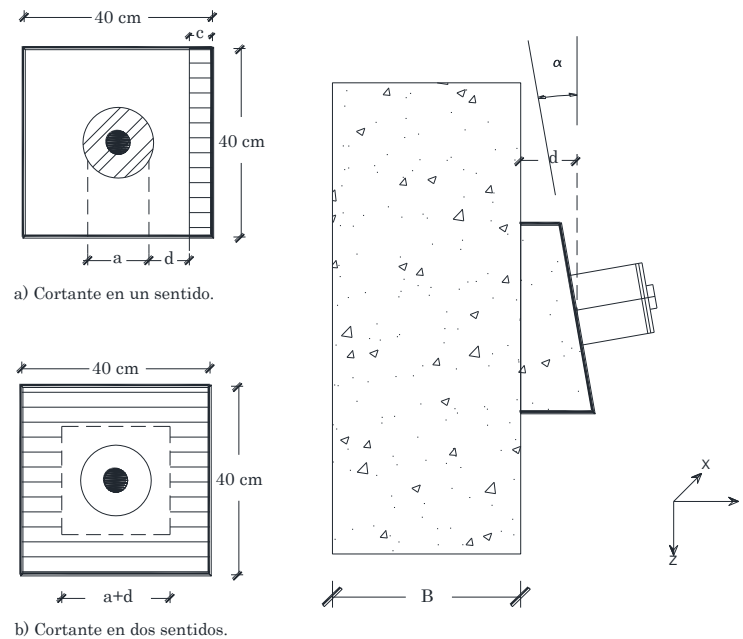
Planta y sección transversal de la zapata de reacción bajo cortante uno y dos sentidos.
